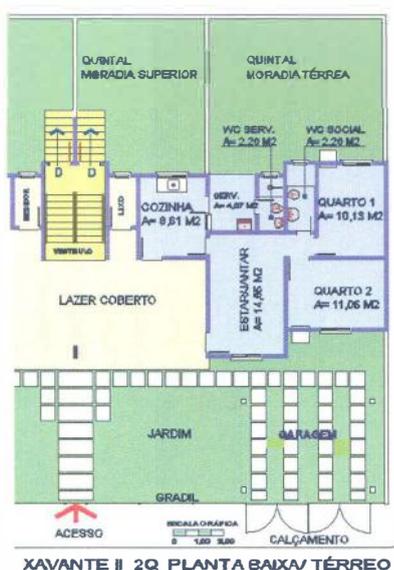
Xavante II. Planta baixa, pavimento térreo - unidade de 2 quartos
